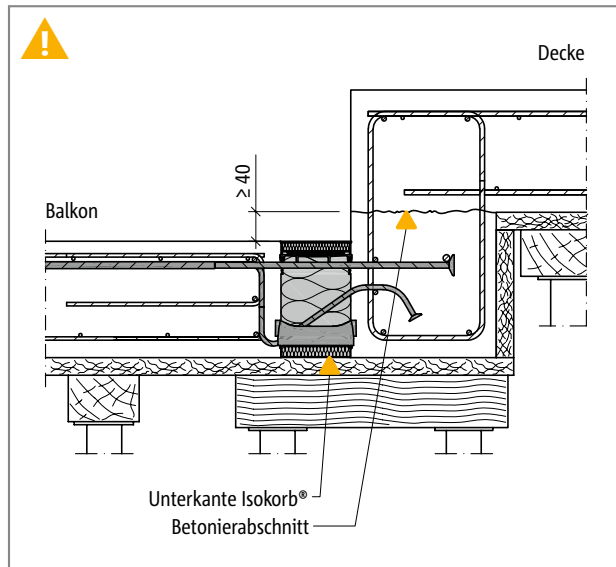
Schöck Isokorb® XT Typ KL-U: Ortbetonbalkon mit Höhenversatz nach unten
